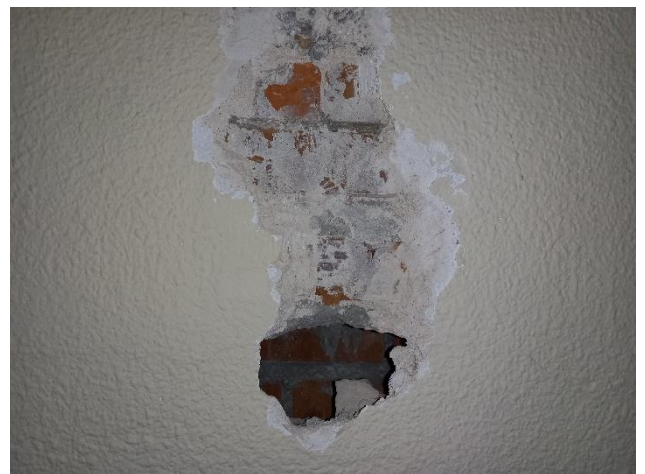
3 hiladas de ladrillo transversal sobre la que apoya la viga.
